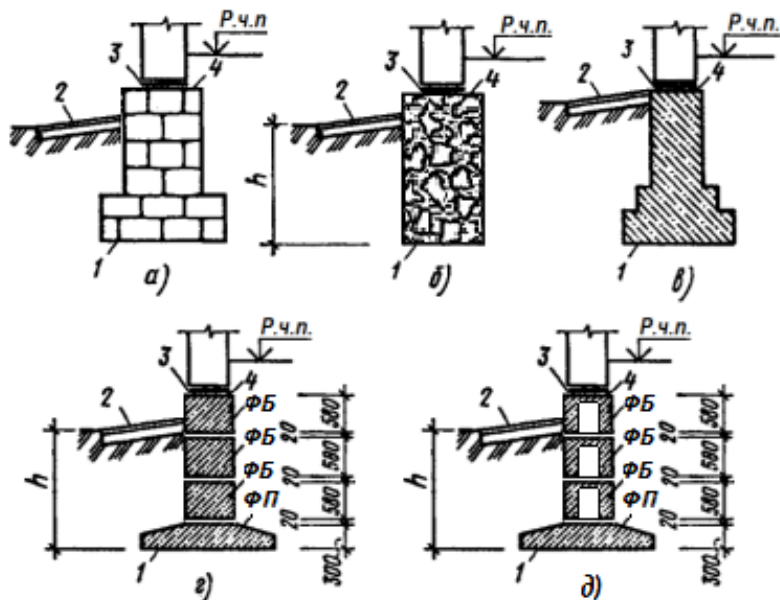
Основні типи фундаментів за конструктивним рішенням: *а* – бутові; *б* – булобетонні; *в* – бетонні; *з* і *д* – збірні залізобетонні; 1 – тіло фундаменту (подушка зі стіною); 2 – відмостка; 3 – горизонтальна гідроізоляція; 4 – цоколь
